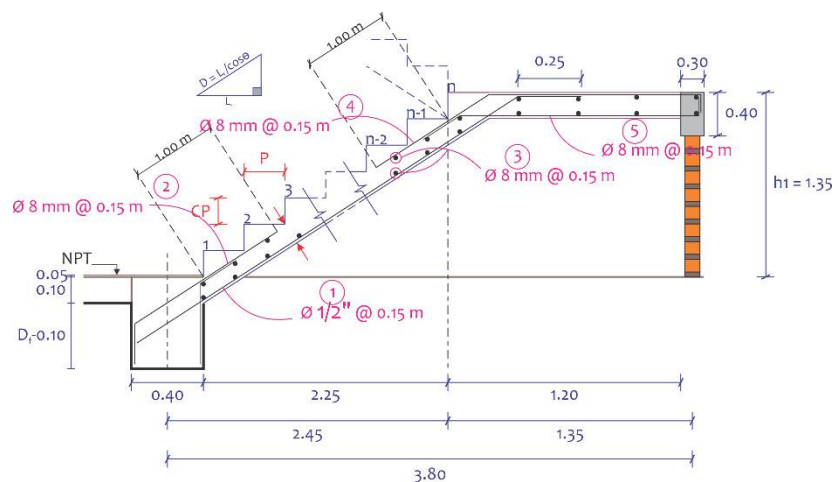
Detallado Final del Primer Tramo de la Escalera.
